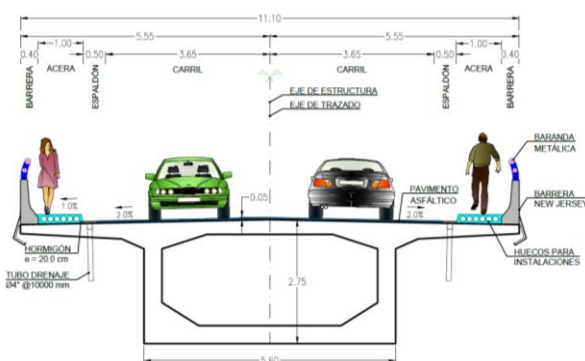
Sección transversal tipo tablero por centro – luz de vano principal.
